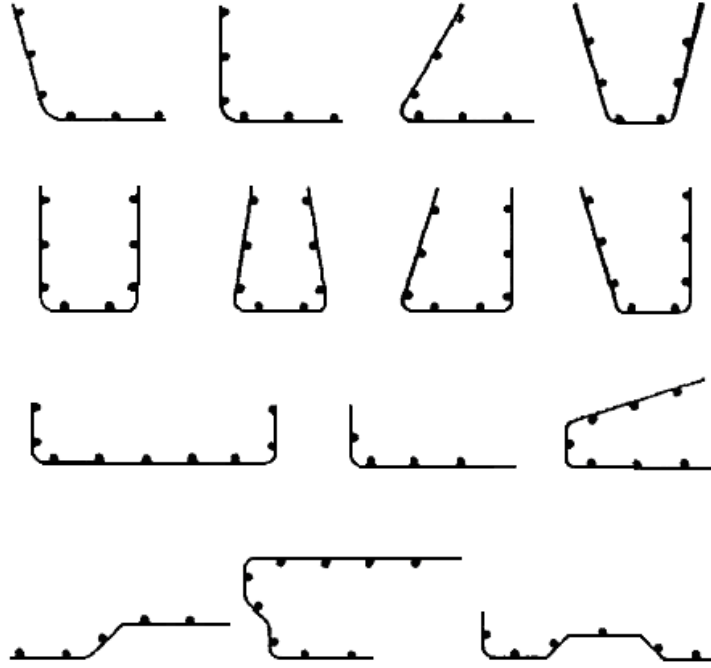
Deprem bölgelerinde uygulanan betonarme perde elemanlarının donatı düzenleri (D.B.Y.B.H.Y. / 2007)
